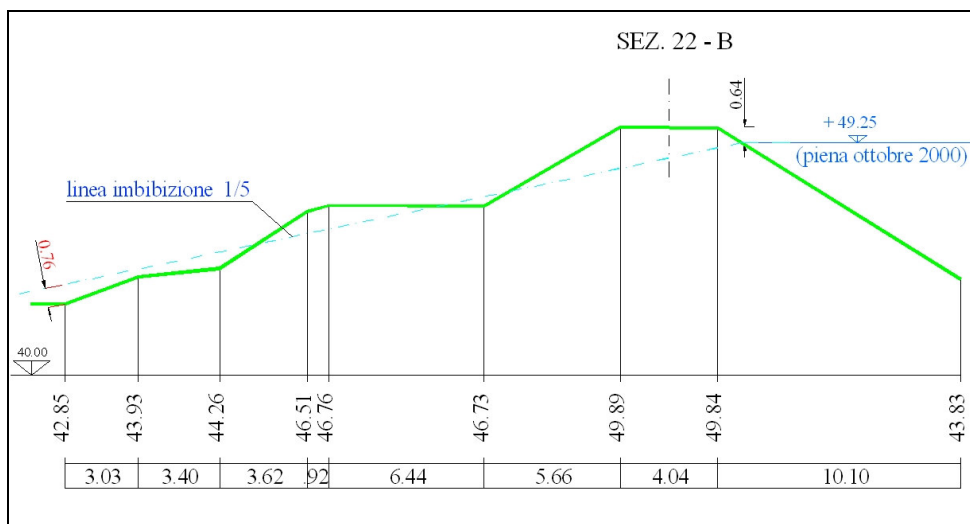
Planimetria tipo dei fenomeni di infiltrazione arginale.
